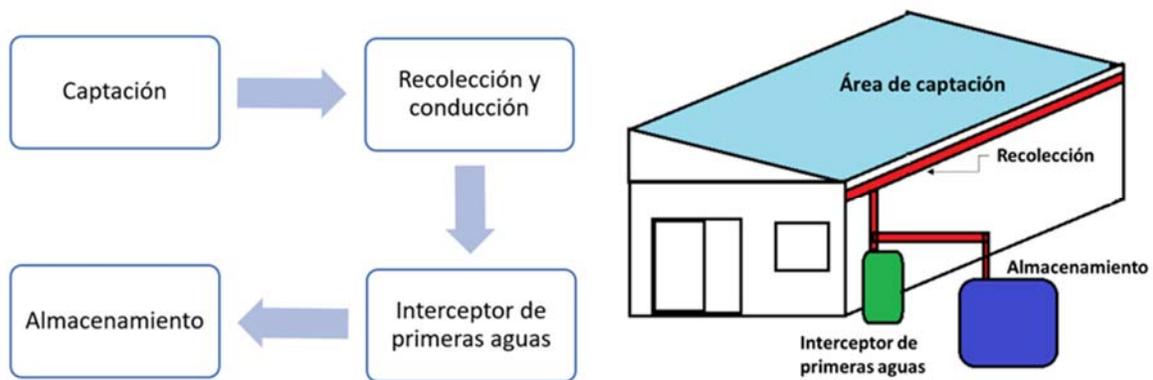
Esquema simplificado de los componentes del sistema de captación de agua pluvial para la planta de secado.
